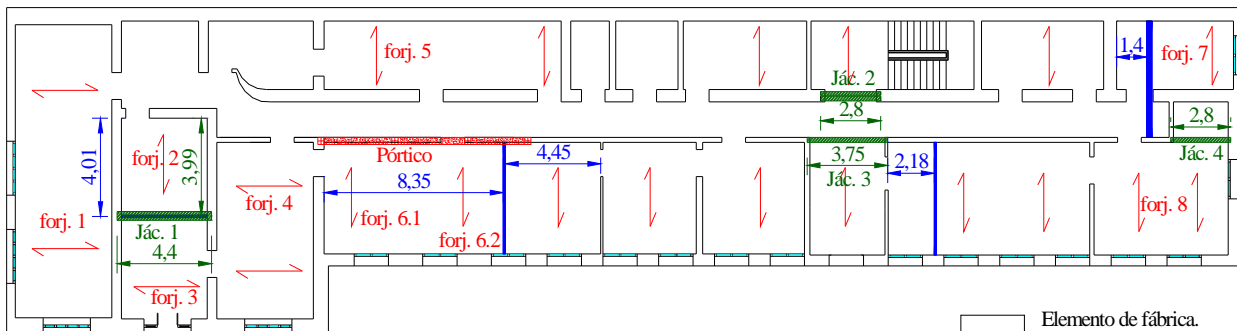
Esquema en planta de los forjados y muros portantes y dinteles de un edificio objeto de rehabilitación.
